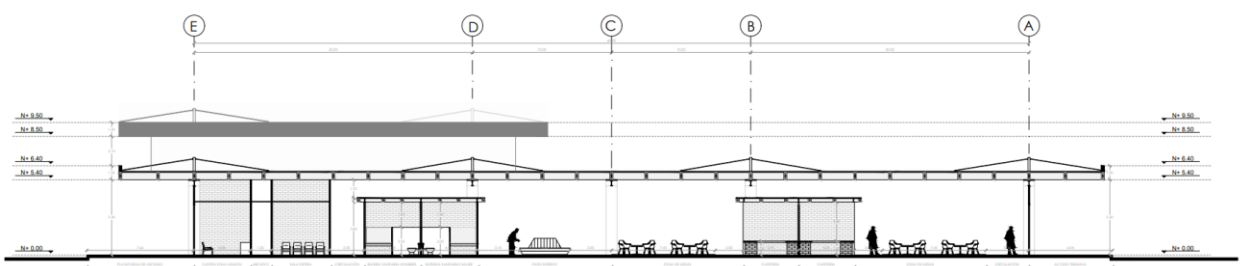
Corte Longitudinal Módulo Taquillas C-C
